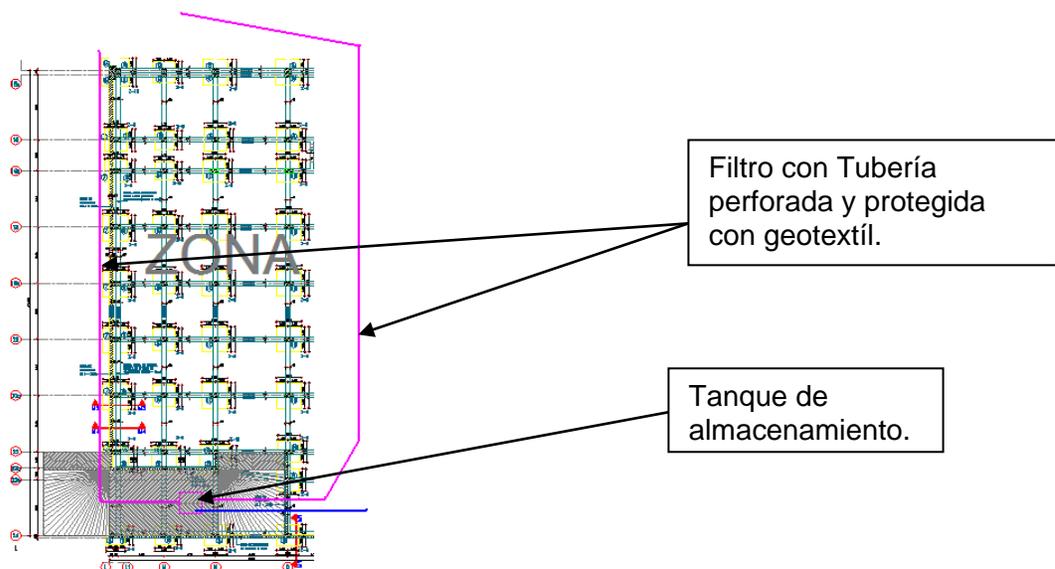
Sistema de drenaje provisional en el área de construcción del parqueadero
